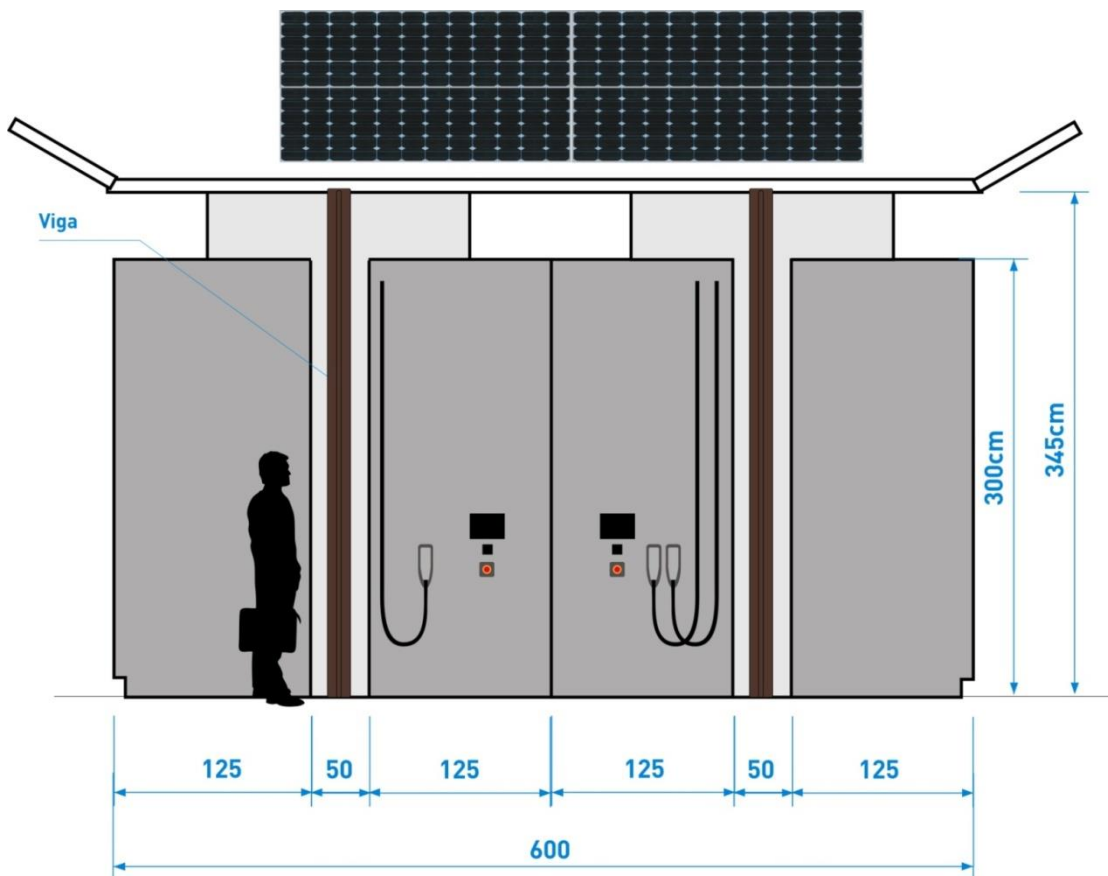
Esquema dimensional de la parte frontal en centímetros.
